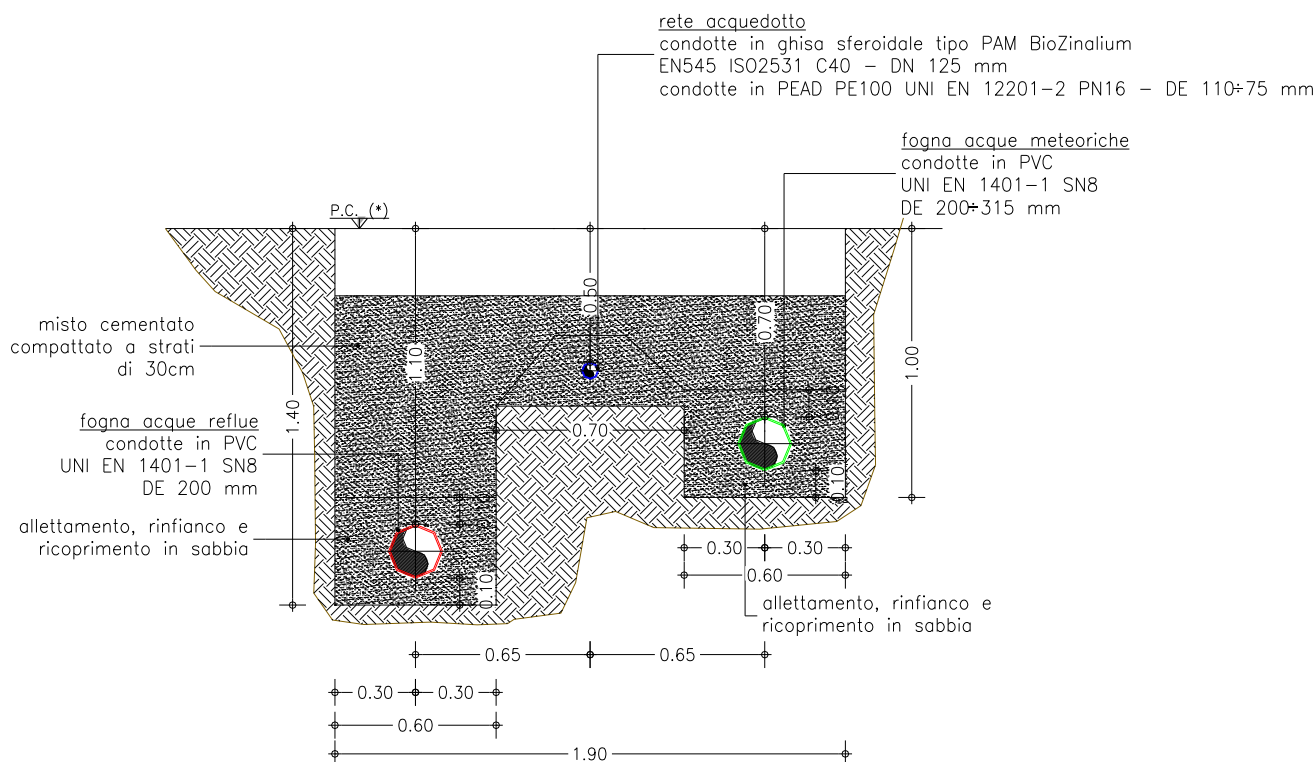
sezione tipo di posa delle condotte nel borgo, caso tre condotte affiancate.
